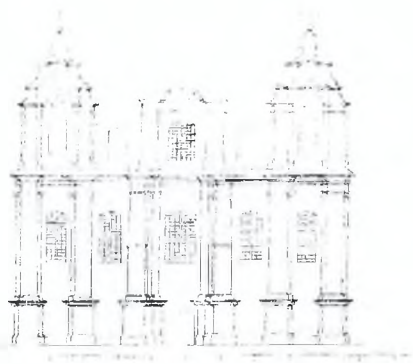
Фасад бывшего костела в существующем виде на 1869 г.
